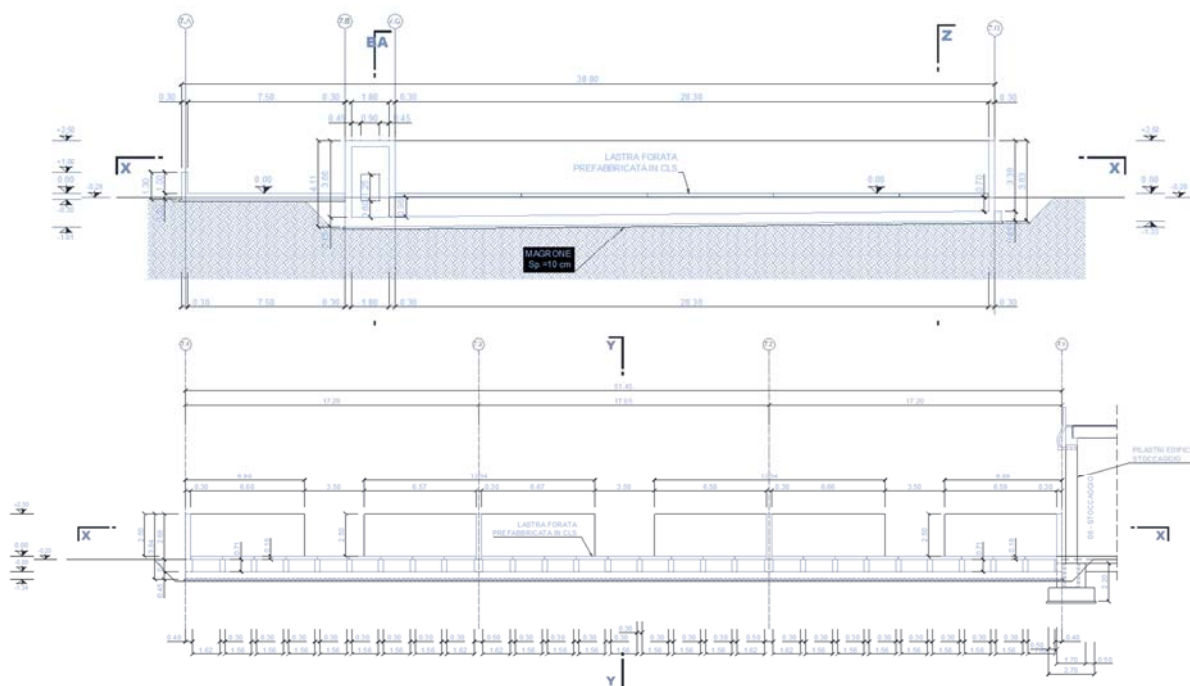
SEZIONE TRASVERSALE BIOFILTRO
